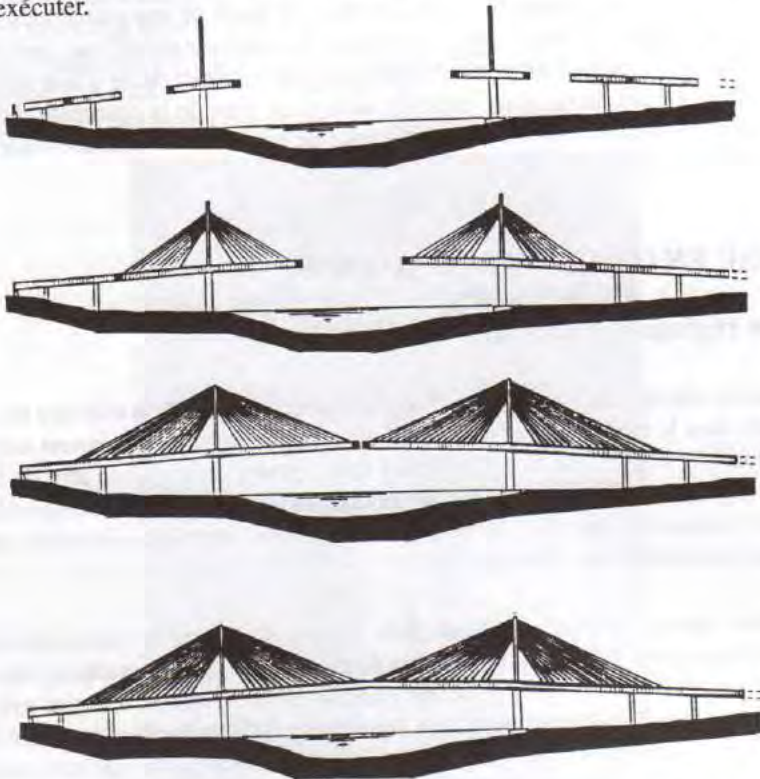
Exemple de cinématique de construction d'un pont à tablier en béton.
